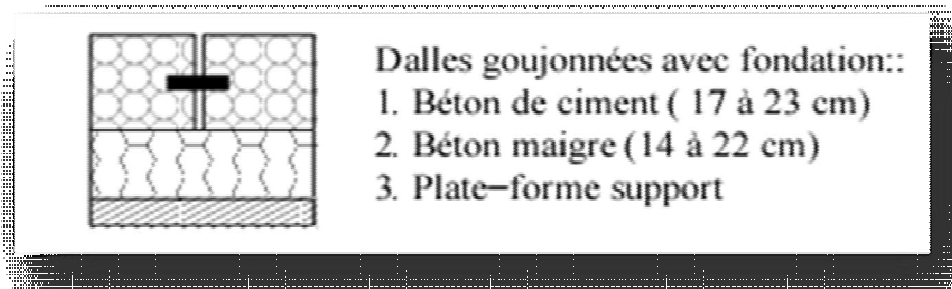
Dalles goujonnées avec fondation [LCPC, 1994] [1]
